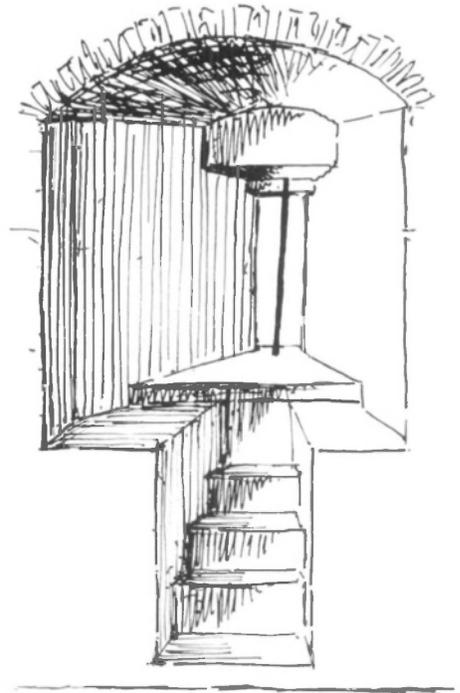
Restitution d'une archère à banquettes au rez-de-chaussée du châtelet.
